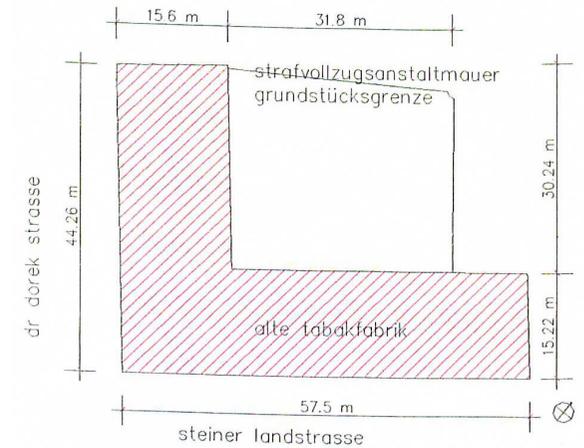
Grundriss alte Tabakfabrik
